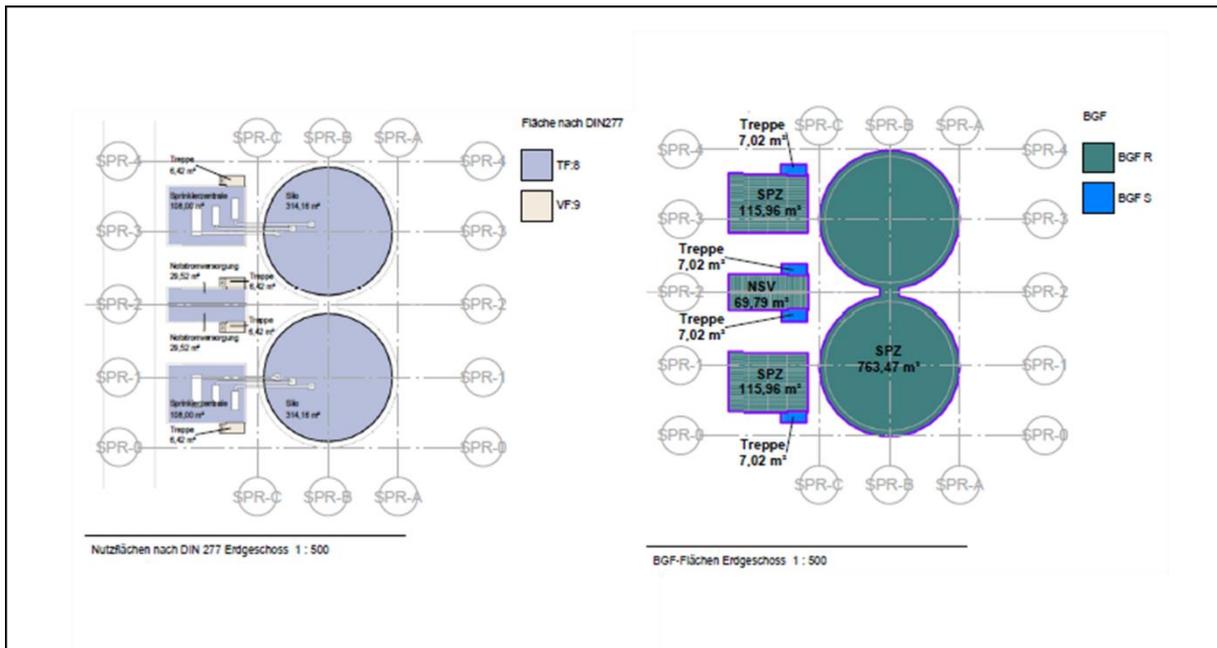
Sprinklerzentrale/ NSV – Grundriss.
